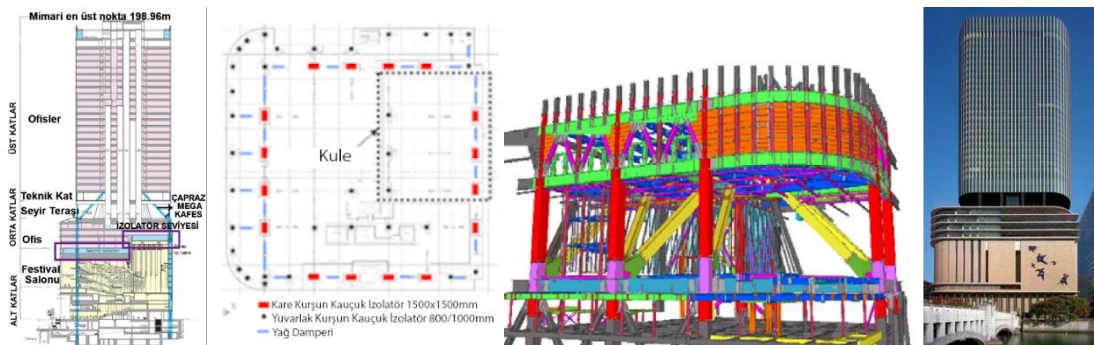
Thousand Tower binası plan, kesit ve fotoğrafı (Komuro vd., 2005)
